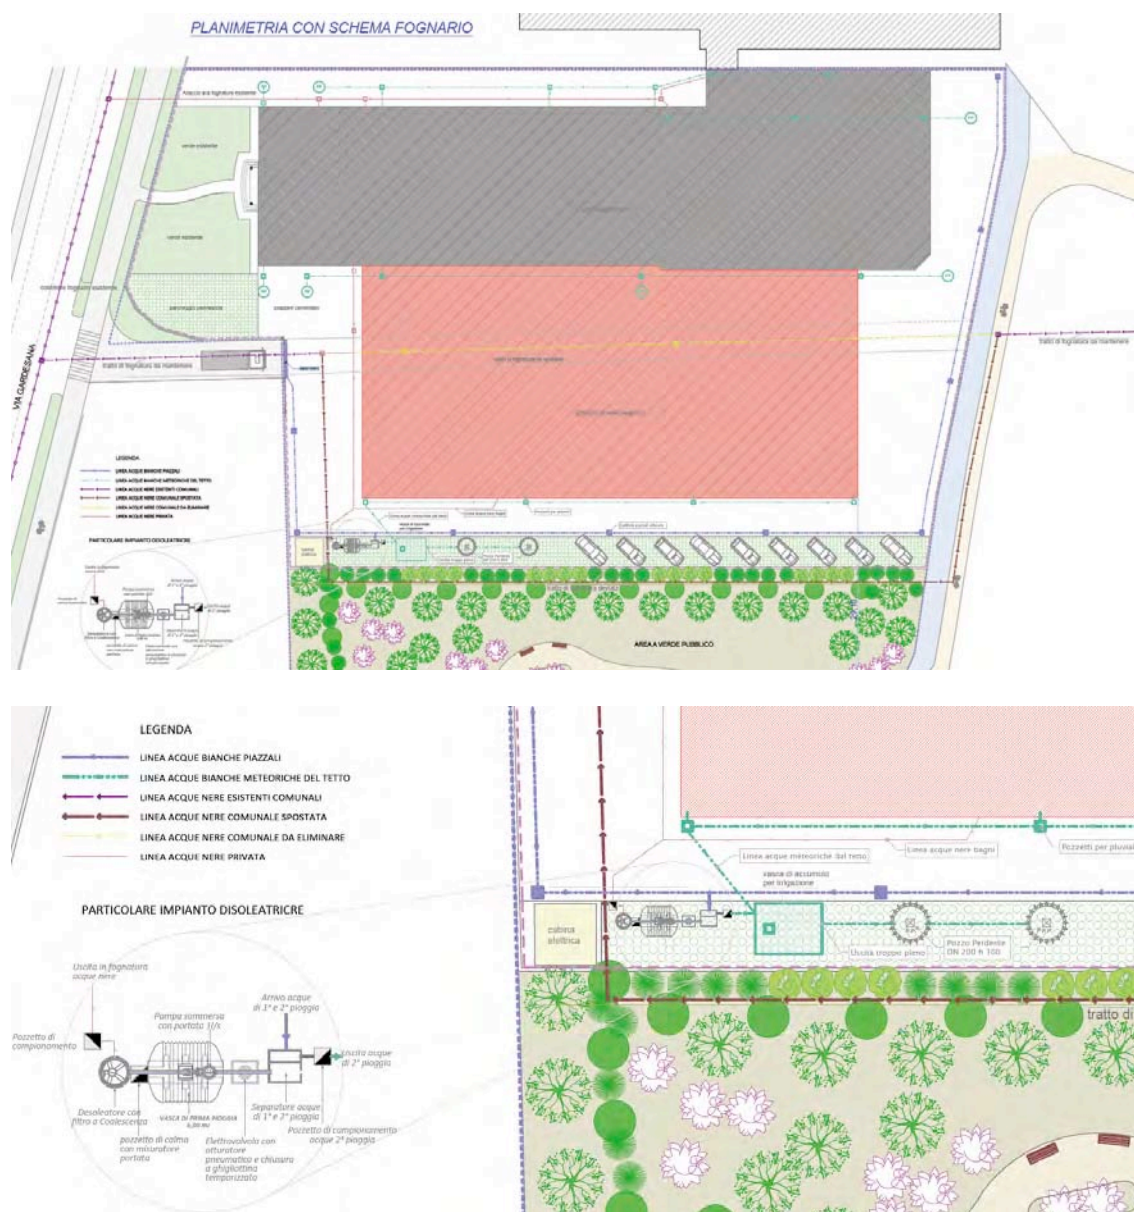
planimetria del nuovo tracciato della rete fognaria (tavola 5 di progetto del SUAP)
